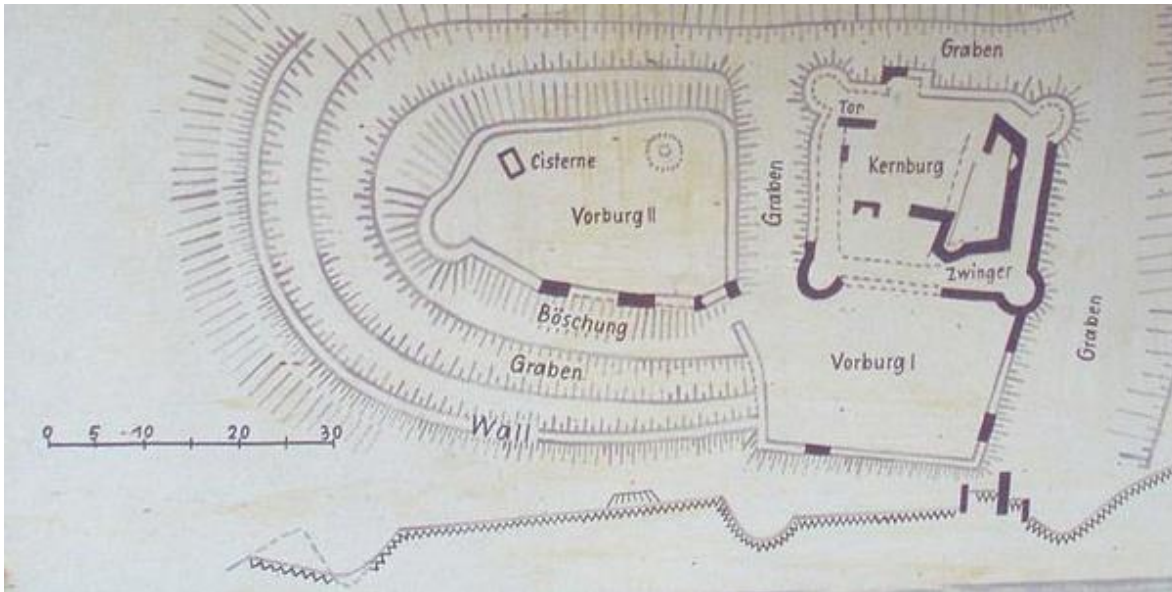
Lageplan der Grillenburg (Infotafel)
